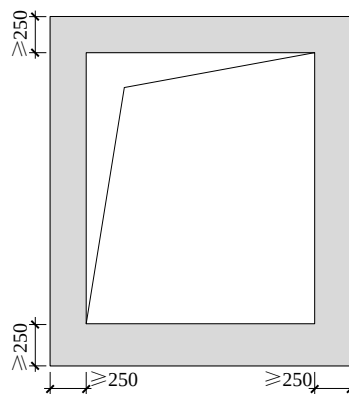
带洞口预制空心墙板尺寸要求示意
